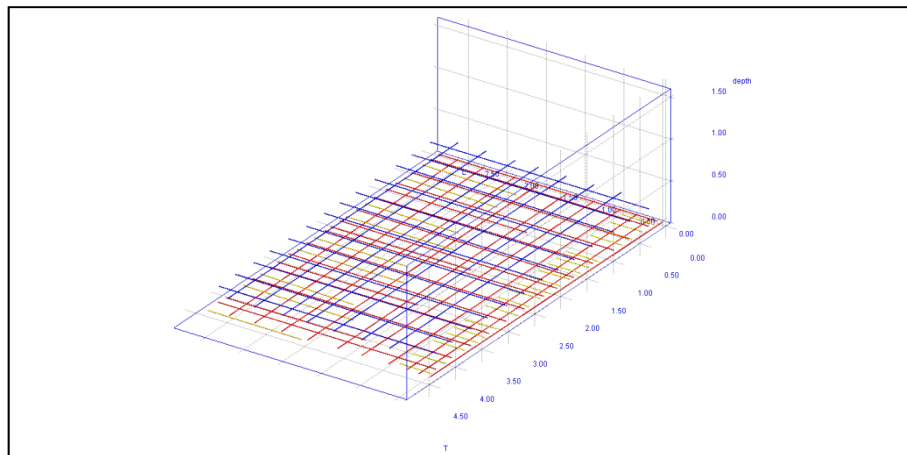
MODELLO 3D, VISTA PROSPETTICA
